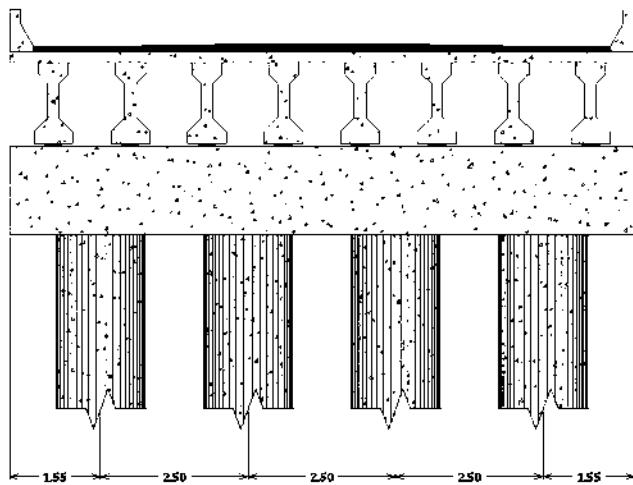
Espaciamiento entre columnas en pilas con altura $h = 20$ m (acotación en metros)
